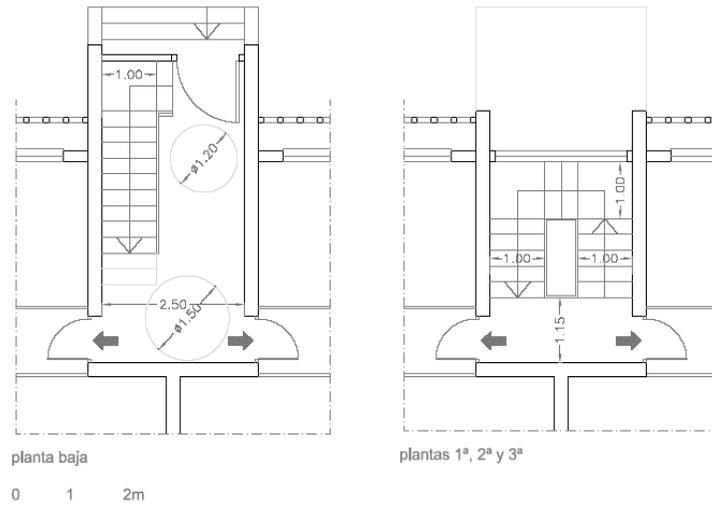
Planos de planta, con la situación actual del ascensor.
